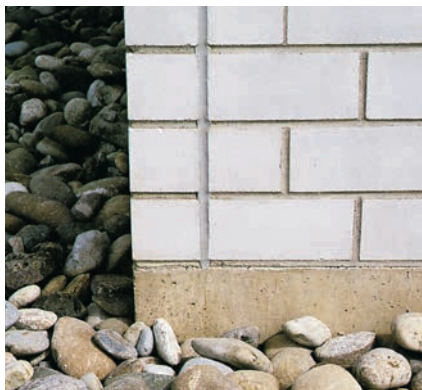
Dehnungsfuge an einer Gebäudeecke mit Dichtstoff verschlossen
